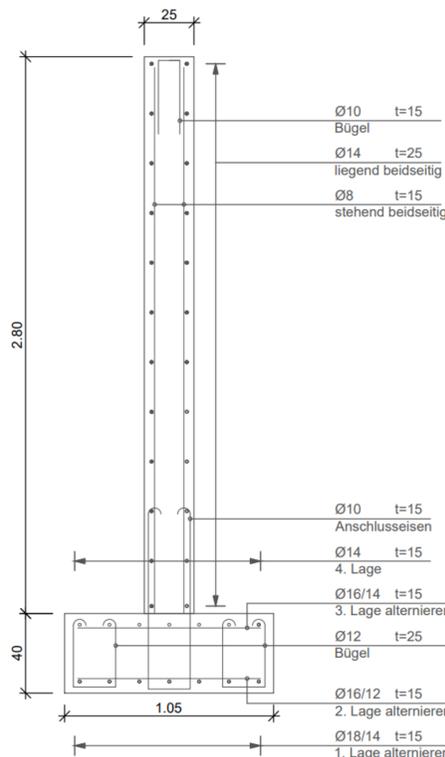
Tragwand 3: Konstruktive Durchbildung im Schnitt
